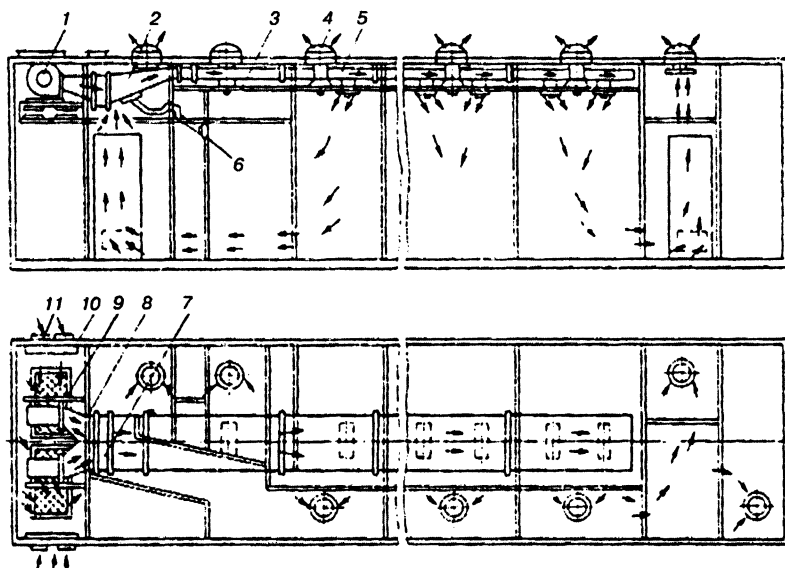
Схема механической приточной вентиляции без рециркуляции воздуха
